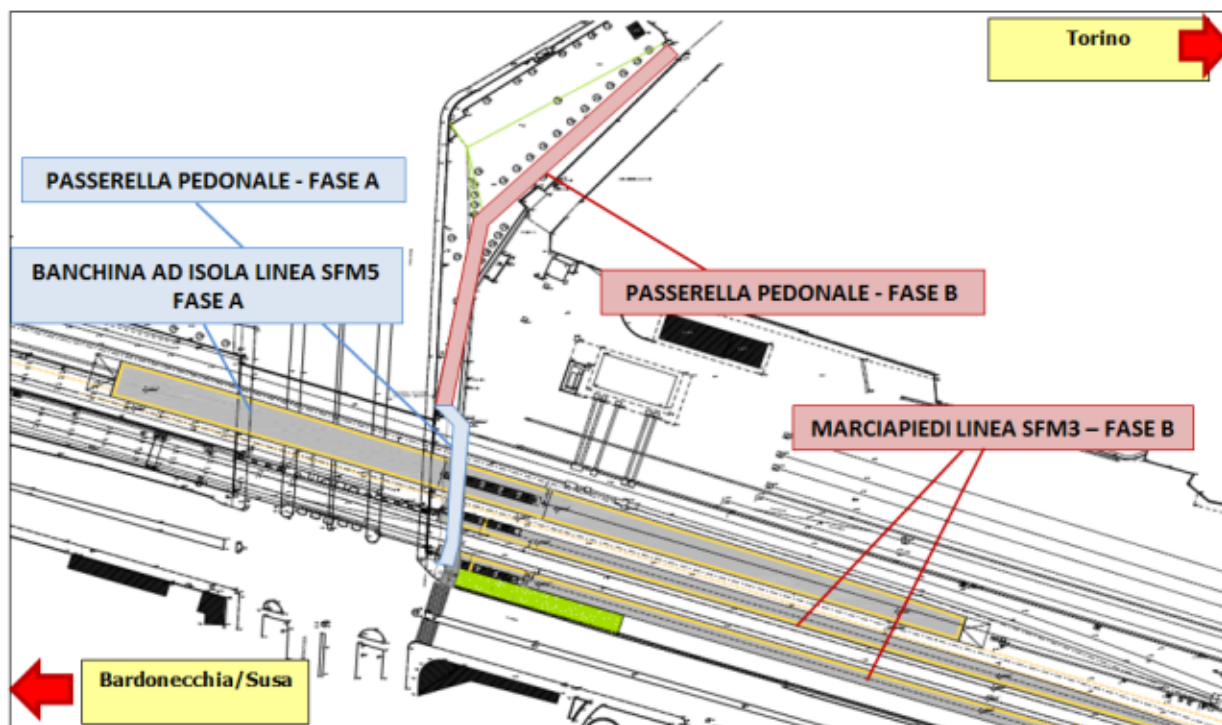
Individuazione degli interventi da realizzare in FASE A e FASE B
